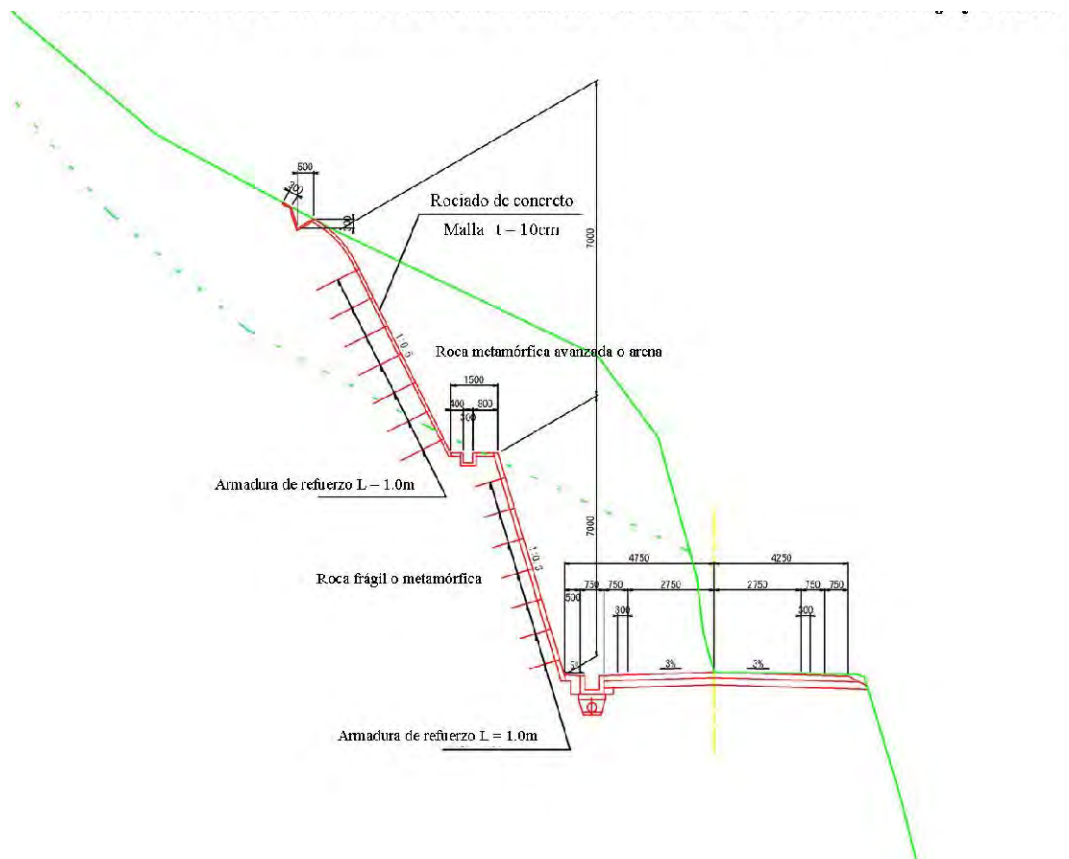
Reforzamiento del talud con rociado de concreto + Construcción de canal de drenaje y bermas
